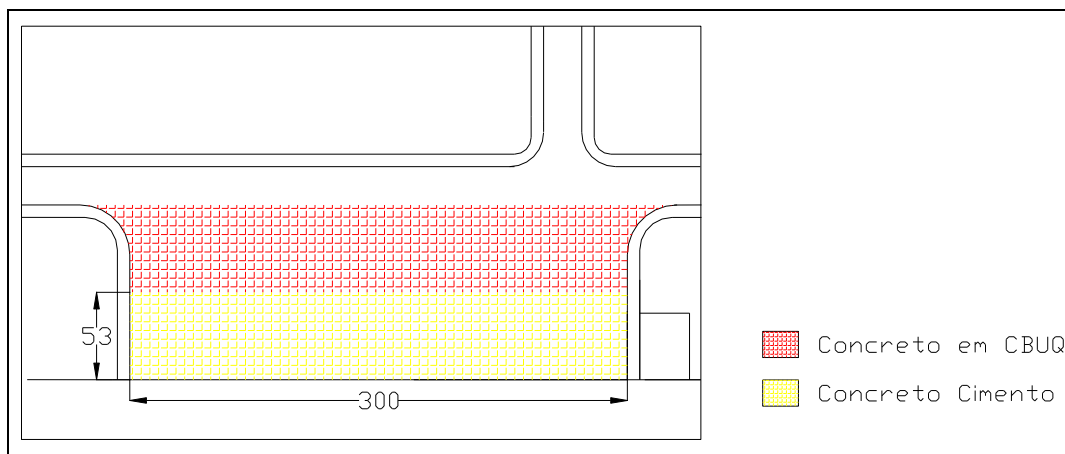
Pavimentação em concreto cimento em parte do Pátio de Aeronaves
